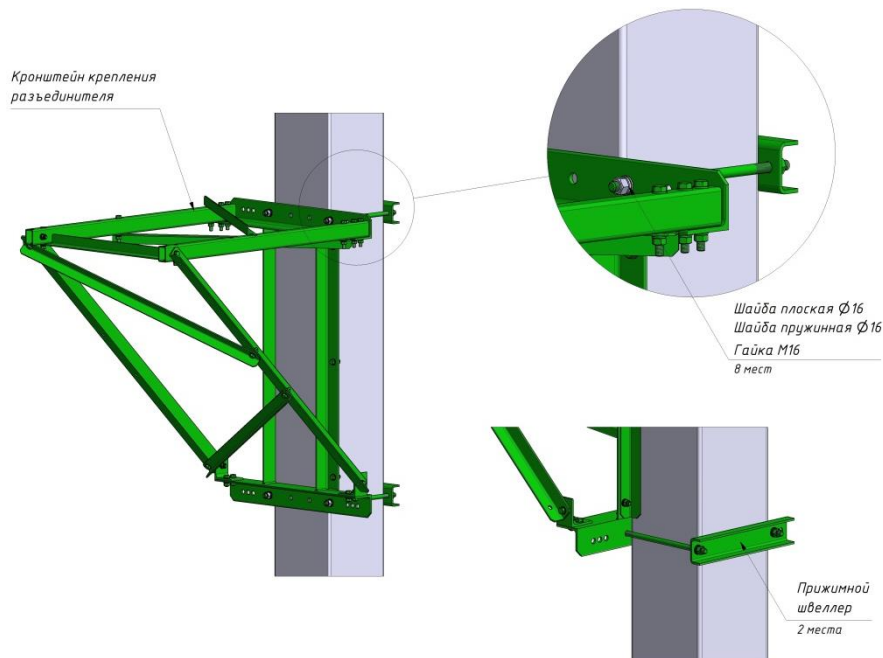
Установка кронштейна разъединителя на стойку СВ 164 и СНВ7-13
